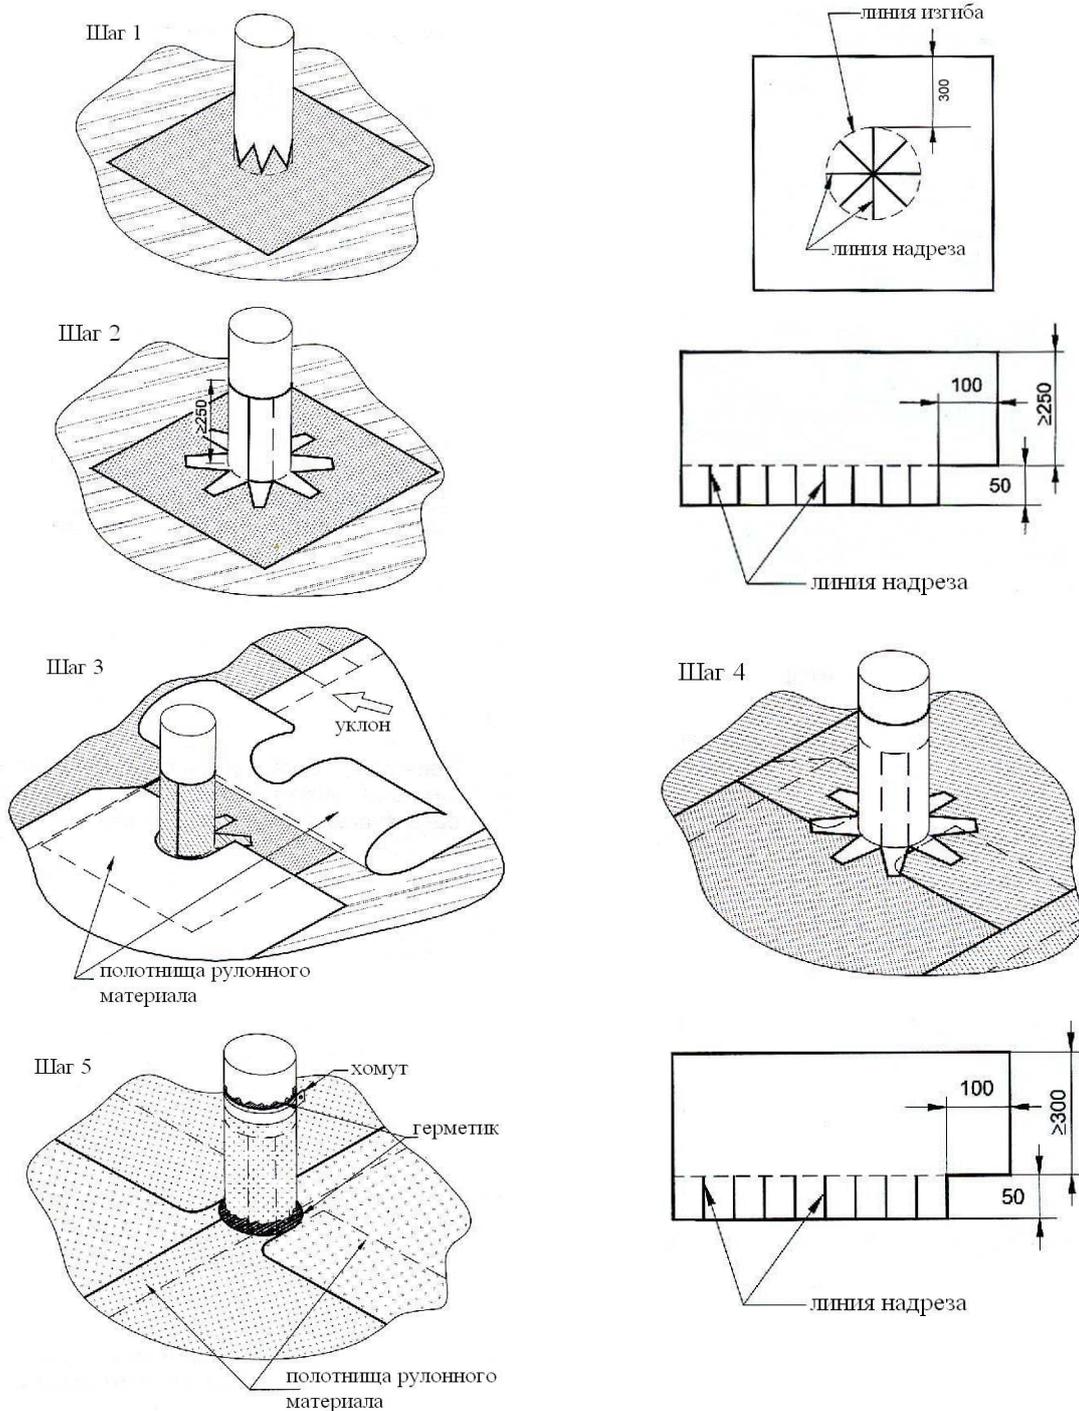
Шаги 1 – 5. Последовательность раскладки полотнищ рулонного материала на примыкании к трубе круглого сечения
